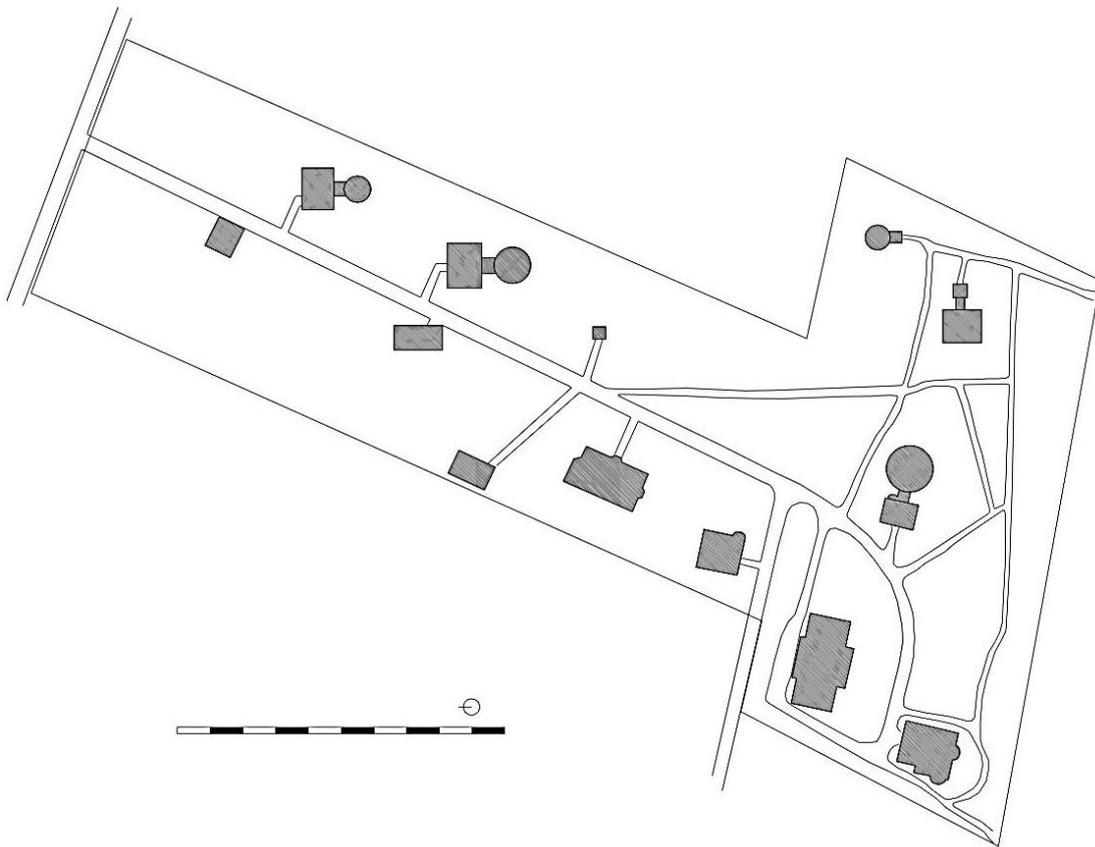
Observatorio de Hamburgo (Bergedorf). Planta de conjunto.
